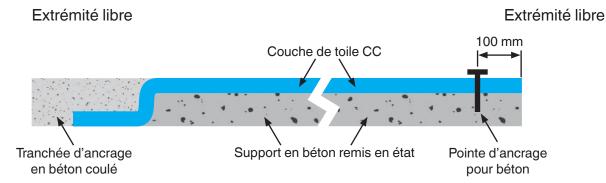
Installation type d'une longue bande continue de toile CC sur un vaste support en béton. Lorsqu'un ancrage est nécessaire, il est possible d'utiliser des tranchées d'ancrage en béton coulé ou des pointes d'ancrage pour béton, selon le cas.
